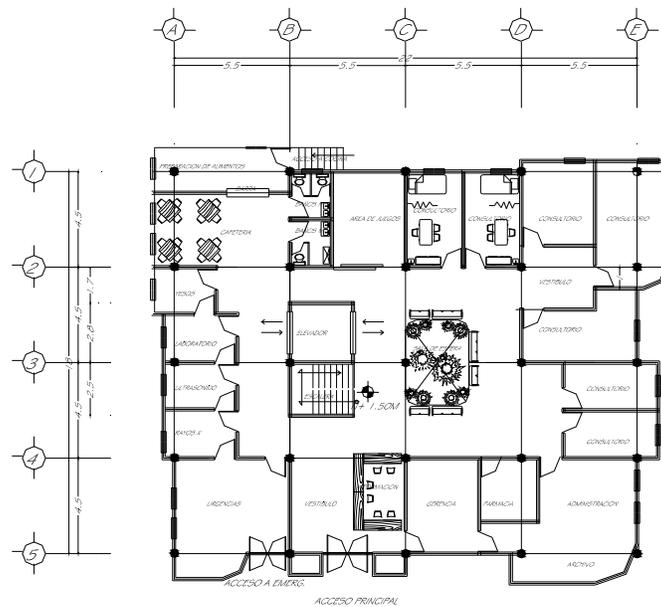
PLANTA NIVEL 1 N+1,50 m
